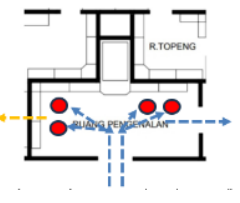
Denah Ruang Jawa Gedung Lama di Museum Sonobudoyo
